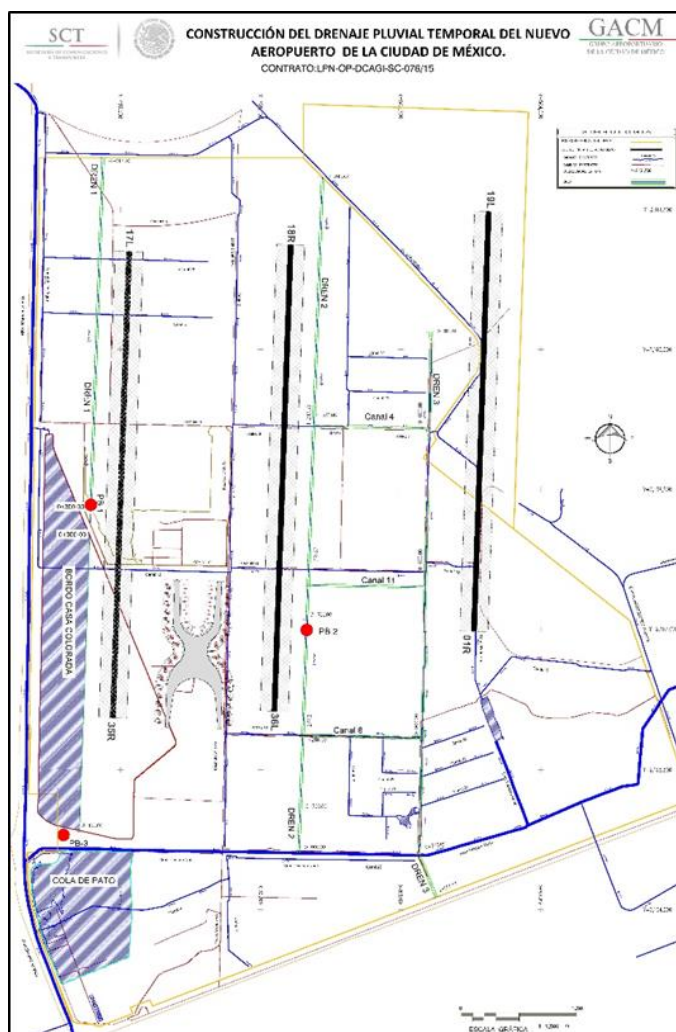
Vista en planta de la zona donde se construye el NAICM.
